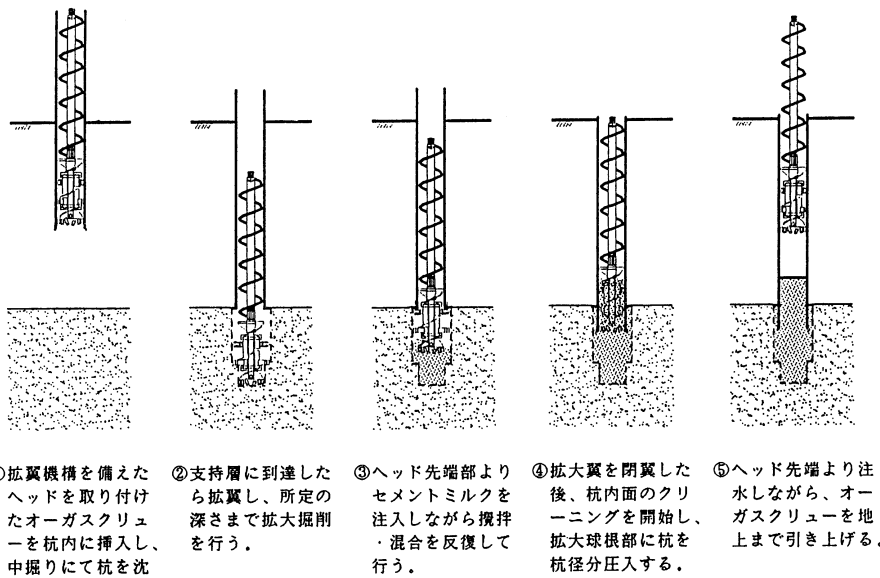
FB9 工法の施工手順 (出典 5.6-① : 施工管理要領)
